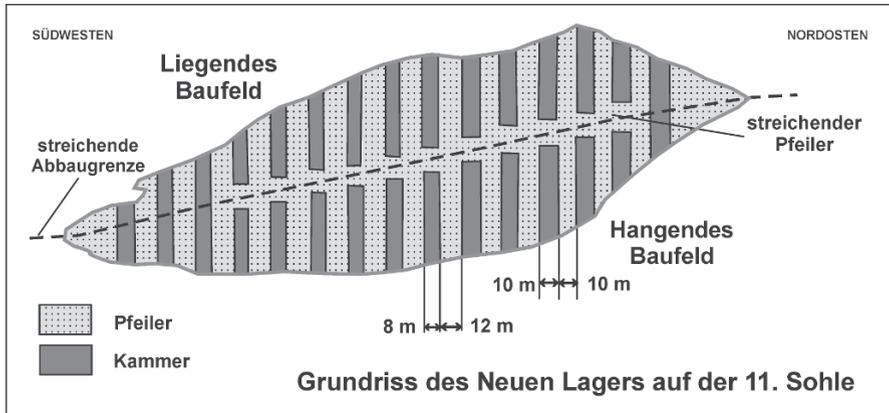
Grundriss des Neuen Lagers auf der 11. Sohle mit dem Einteilungsschema für den Kammer-Pfeiler-Bau (umgezeichnet nach Bartels 1988)
